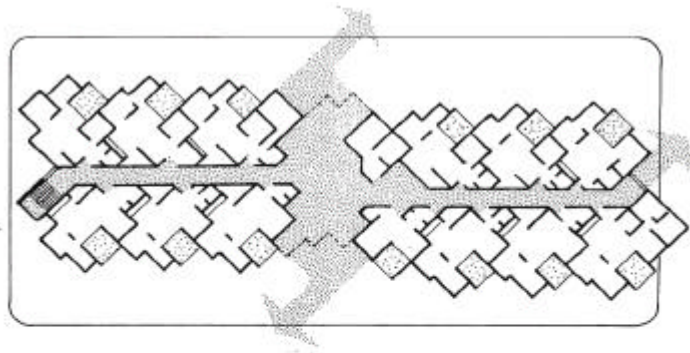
Inmueble construido en Le Grau du Roi (Gard, Francia. Arq. Georges Candilis) (F.: Candilis, 1973)
